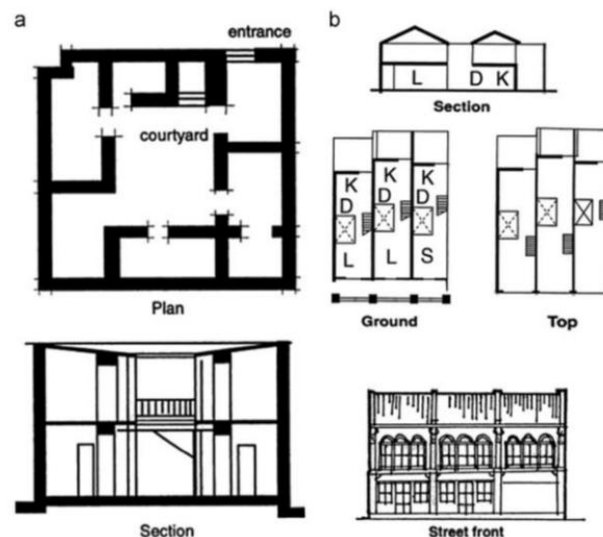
Plan et section d'une maison de l'ère mésopotamienne (a), section, plan et élévation d'un « shop house » en Malaysia (b).
